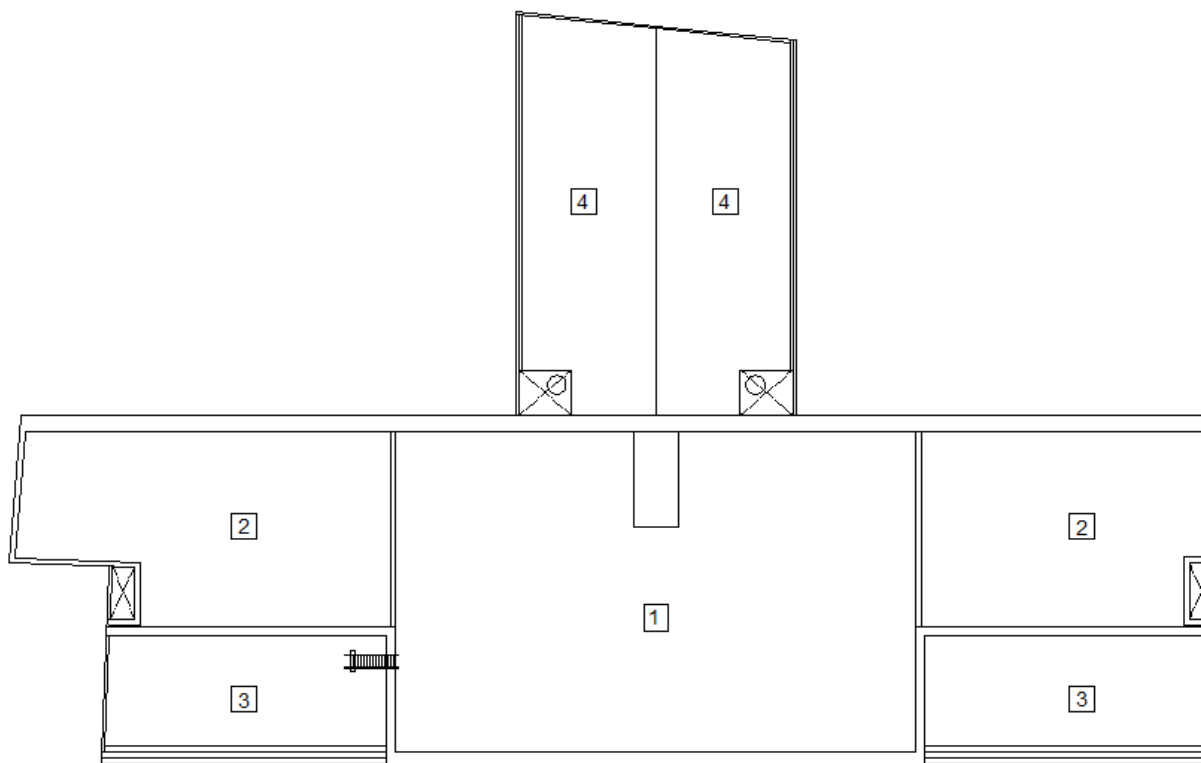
Tipos de cubiertas en el edificio principal. Fuente: Elaboración propia.
